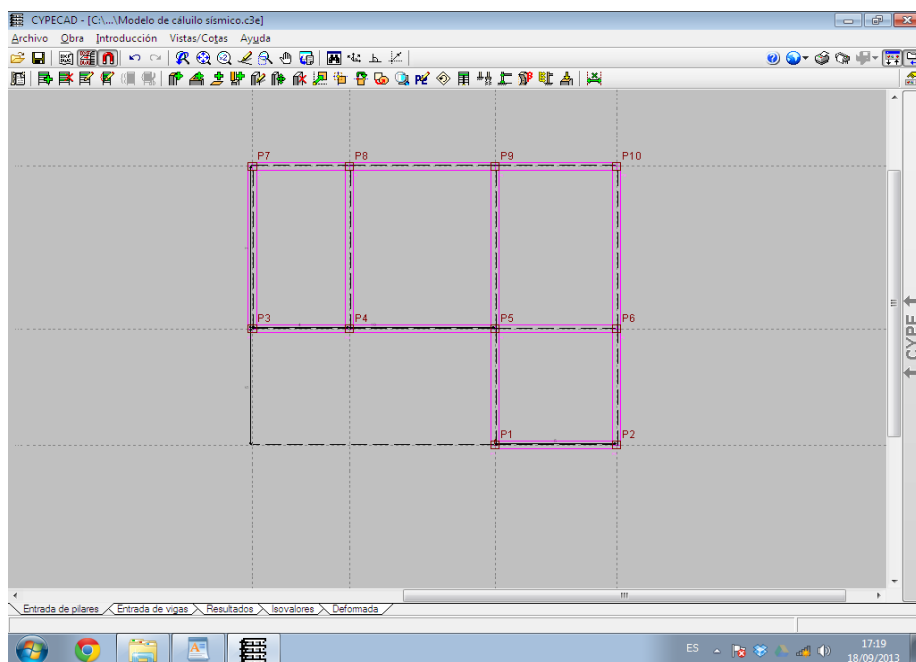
Planta baja del ejemplo de cálculo. Pilares y vigas asignados.
